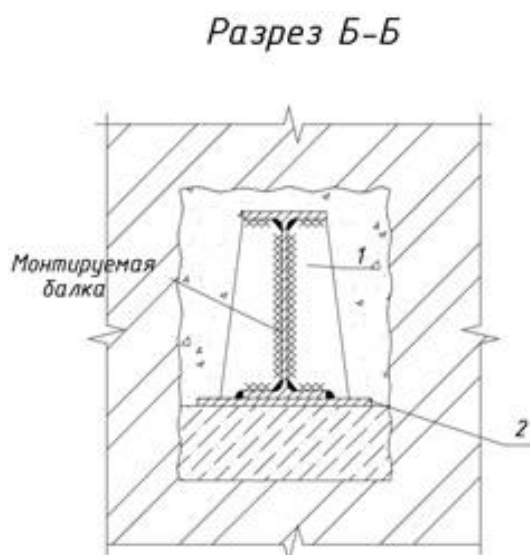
(В). Узел опирания балки на кирпичную кладку. Разрез Б-Б.
